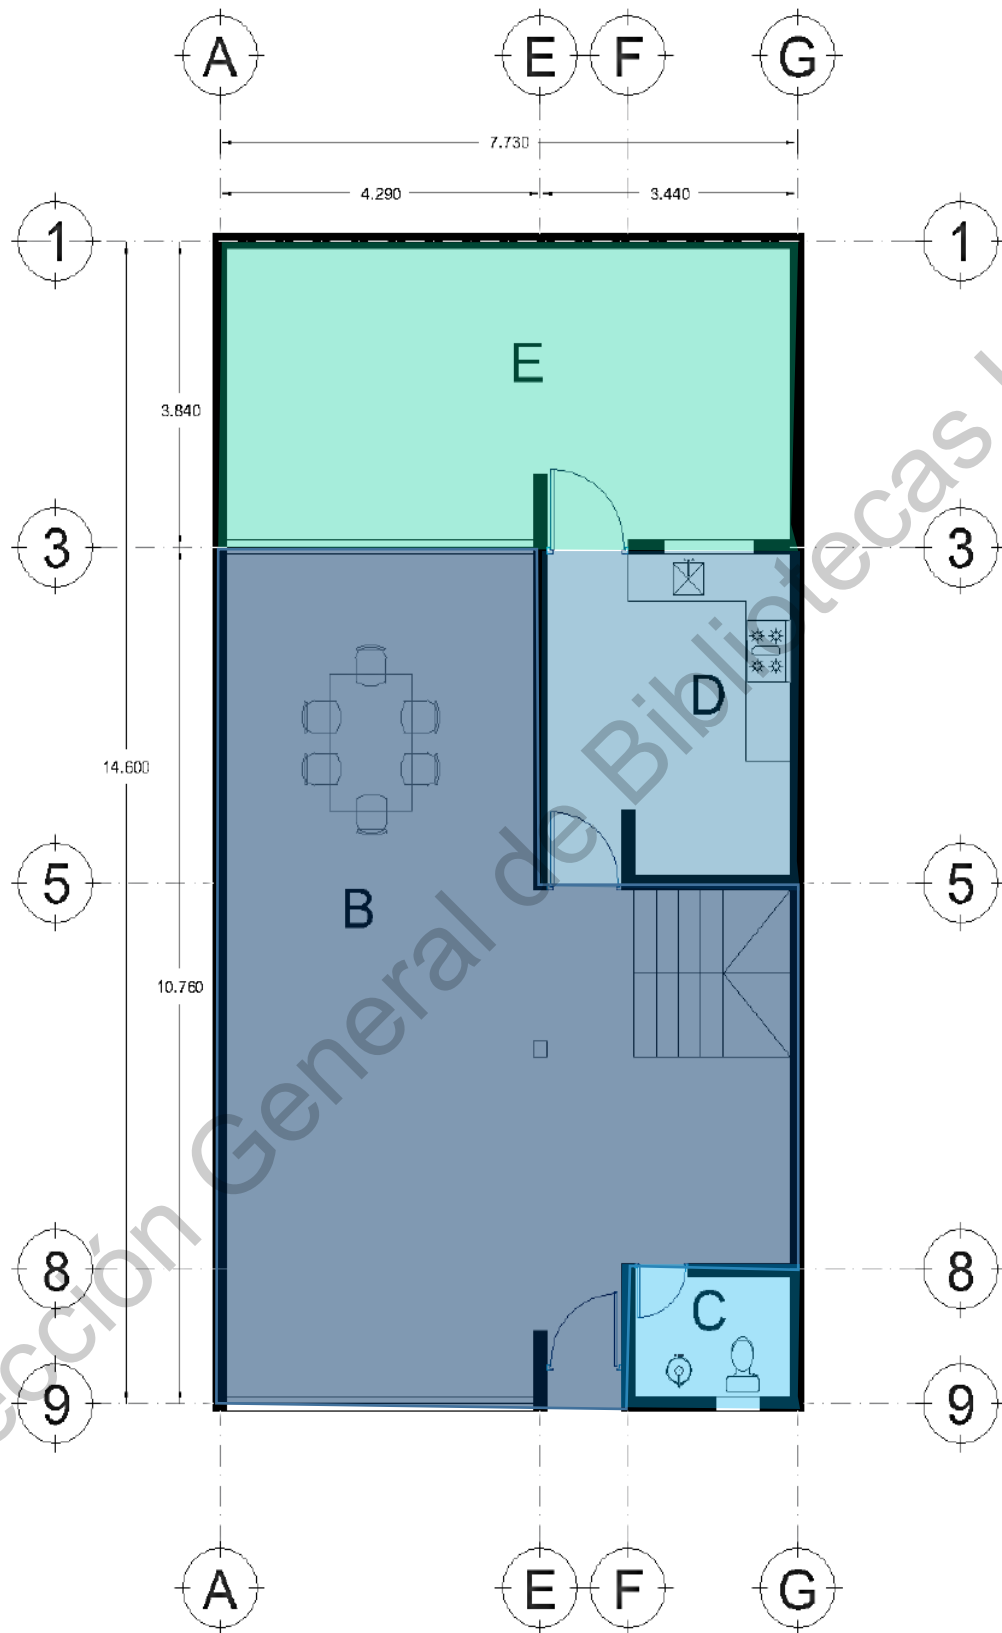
Planta baja. Casa Corregidora. Zonificación. Ecotect
